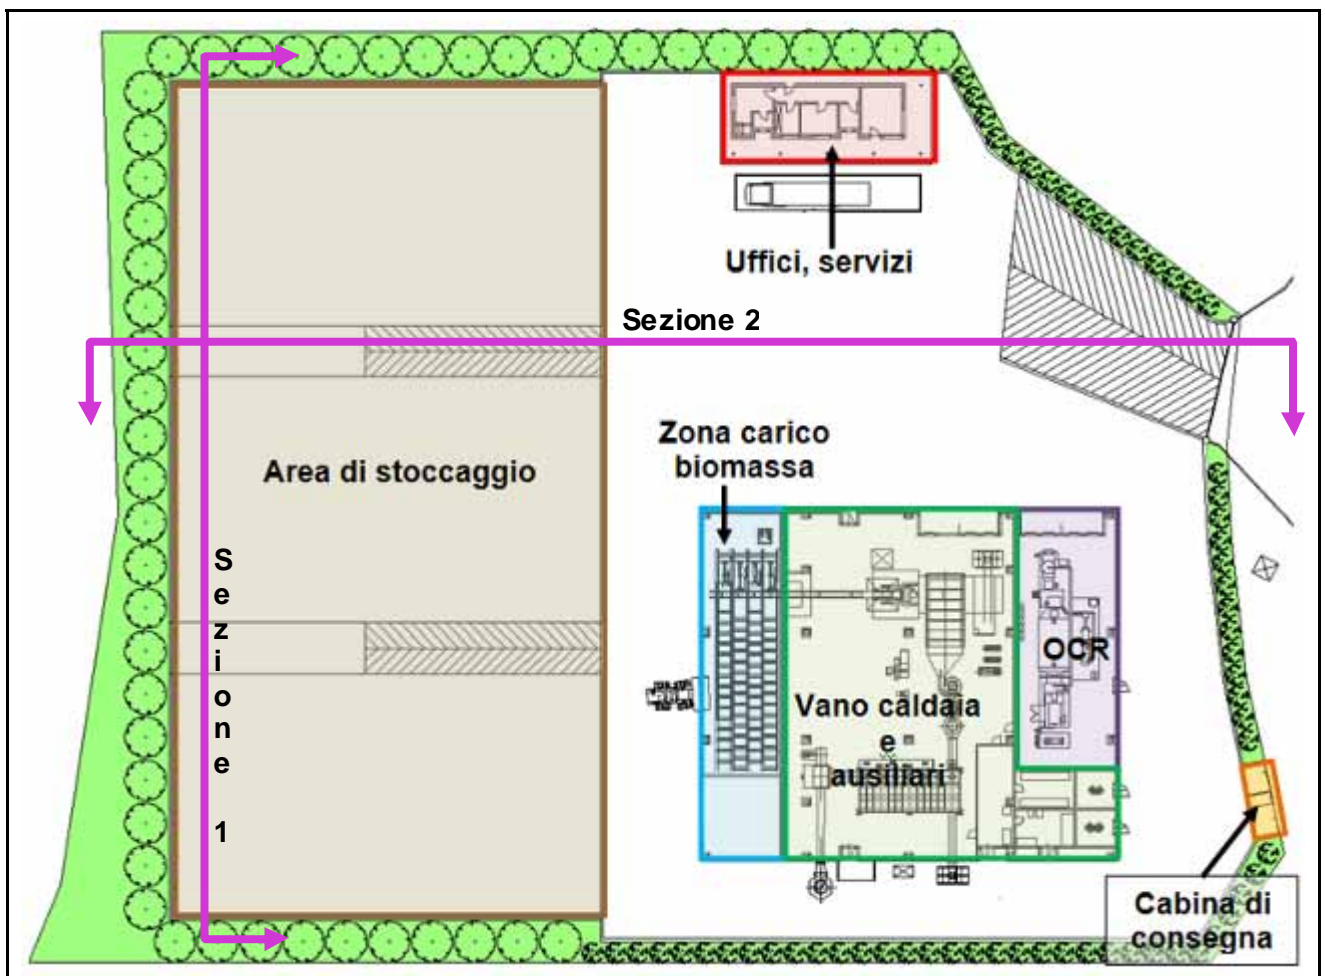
Planimetria dell'area di progetto (con indicazione delle sezioni).
